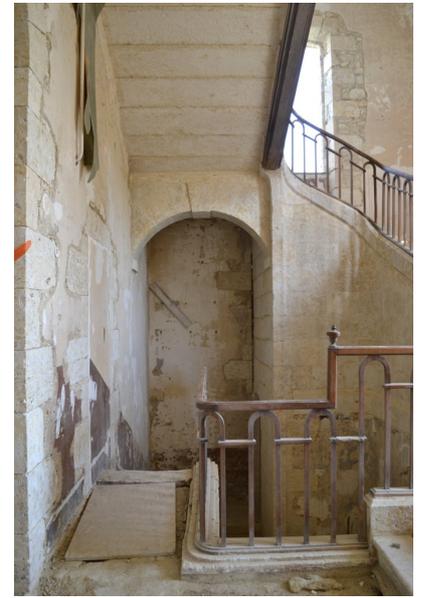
Logis, rez-de-chaussée, escalier d'honneur, volée descendant vers l'étage de soubassement (travaux en cours).
